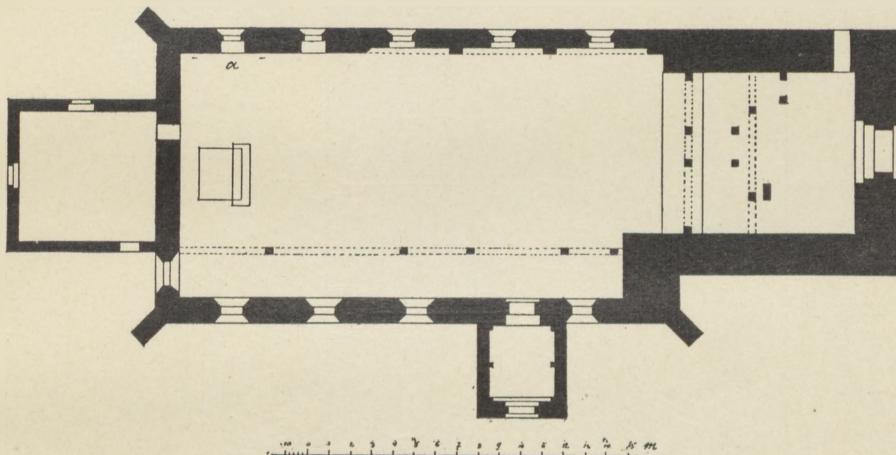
Grundriss der Kirche zu Seesten.
